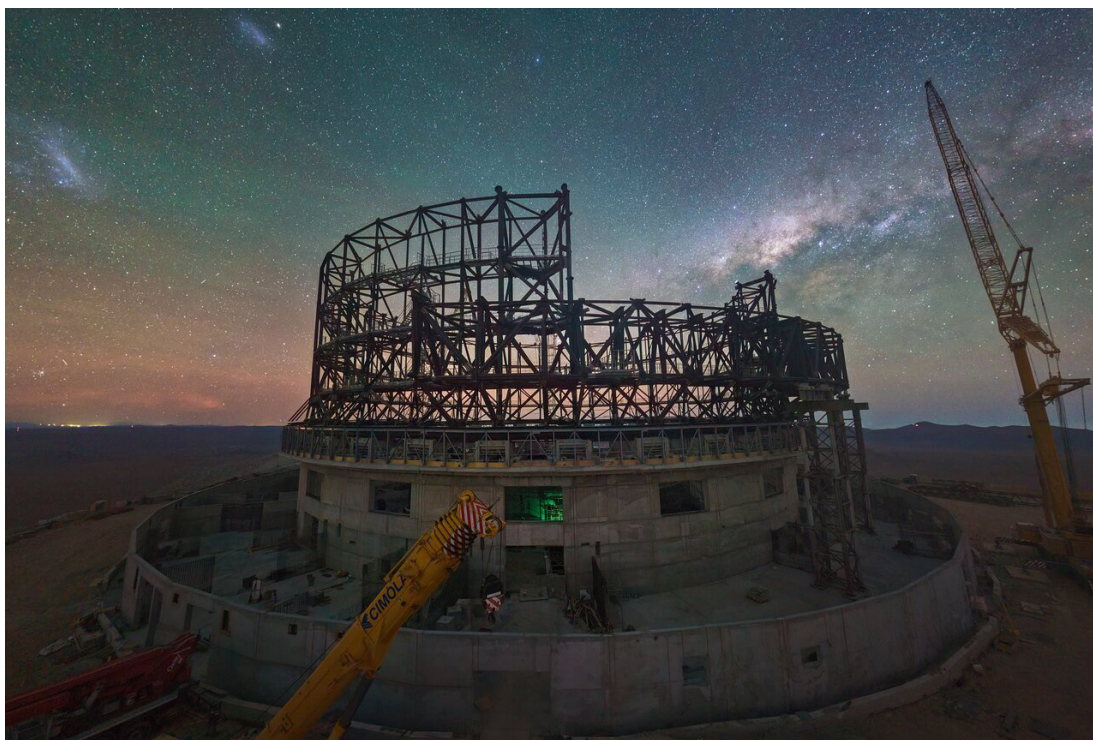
Extremely Large Telescope en construcción en una imagen de junio de 2023.
